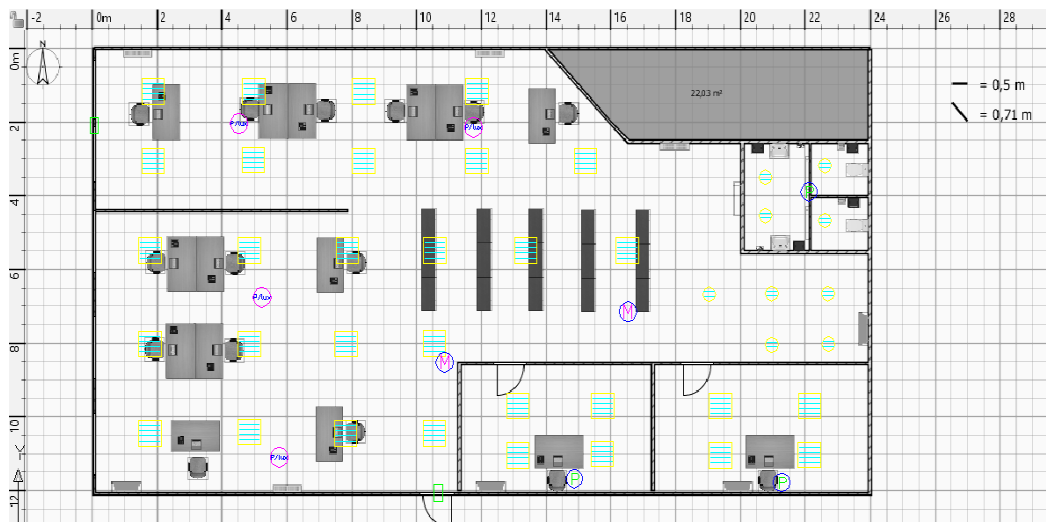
Planta do piso 7, equipada com as luminárias existentes e sensores propostos.
